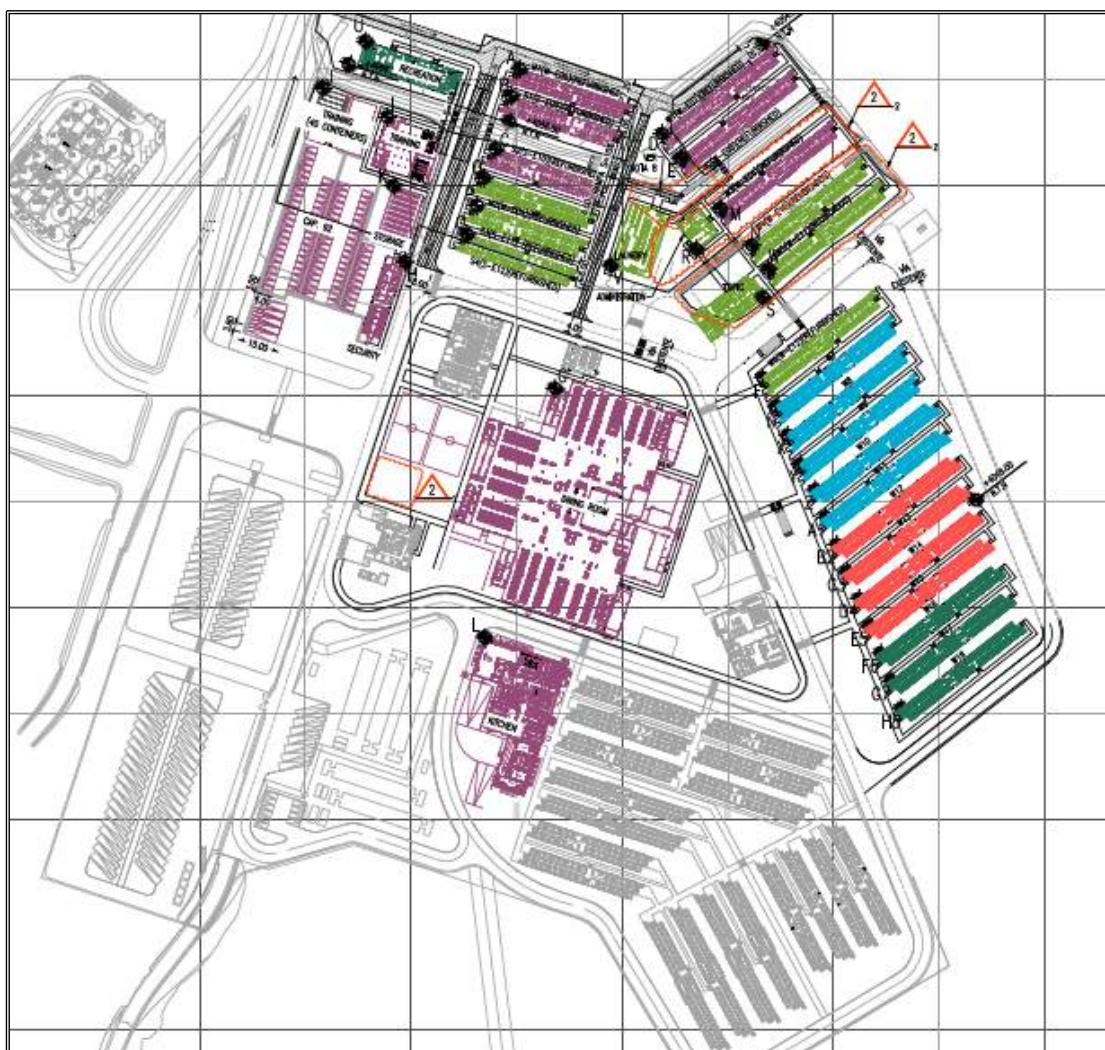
Vista en Planta del Campamento Km 52 (Existente y Ampliación)
